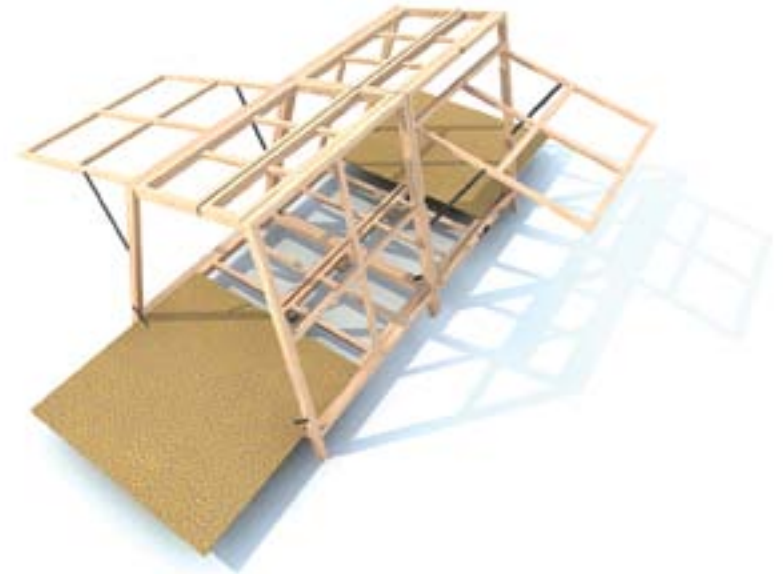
Detalles constructivos del prototipo. 2011. Fuente: FARUSAC.
